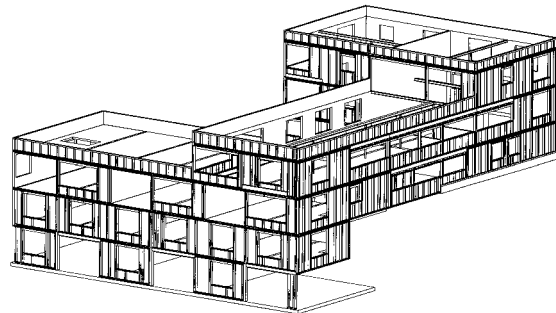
Holzkonstruktion einer Gebäudeeinheit
